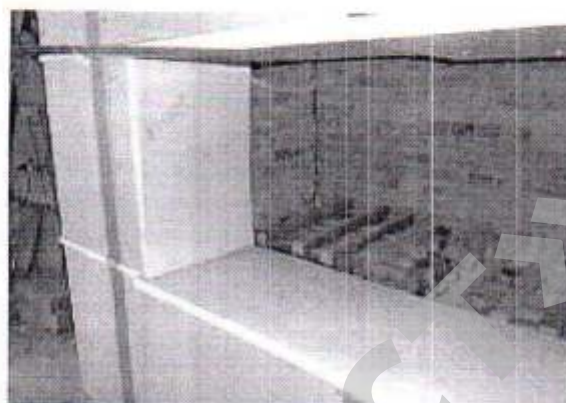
Б. Фрагменты образца фасада до испытания по ГОСТ 31251-2008.
